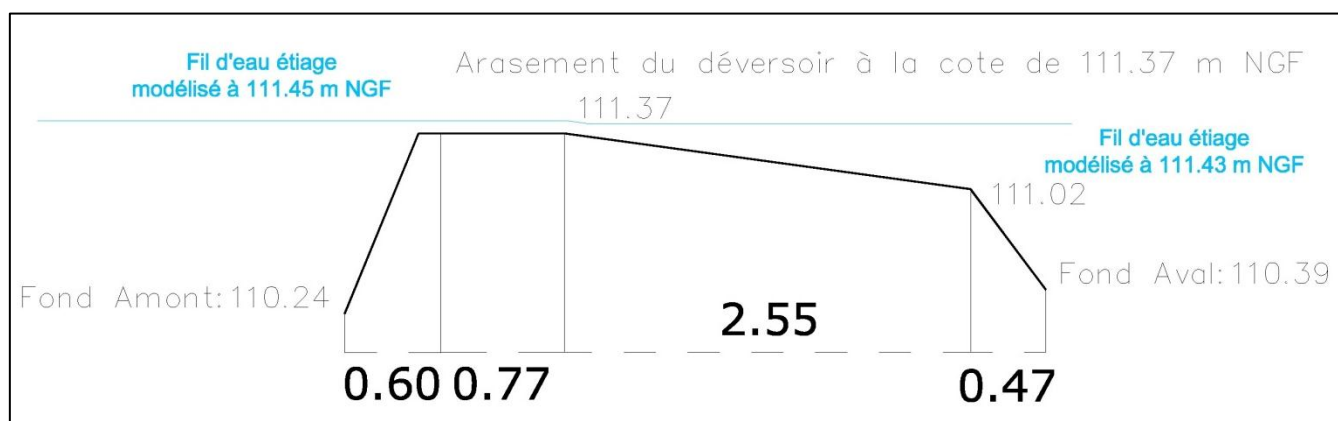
Coupe longitudinale du déversoir rive droite, PROJET
